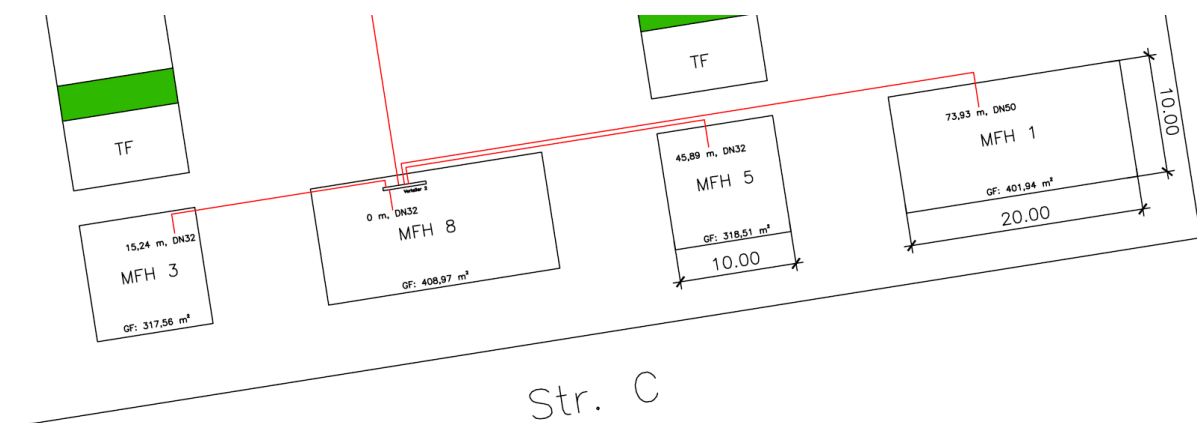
Auszug aus dem Lageplan des Ludmilla Wohnpark Landshut.
